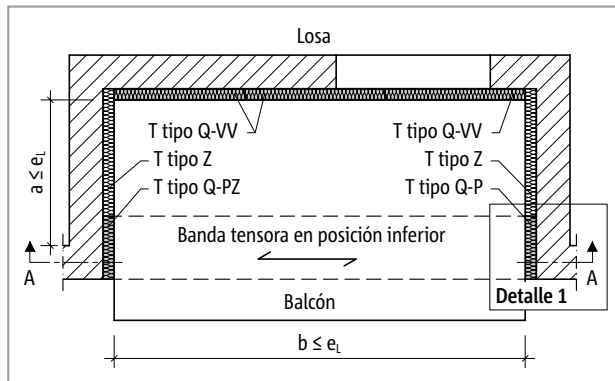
Schöck Isokorb® T tipo Q-PZ, Q-P: Plano logia
